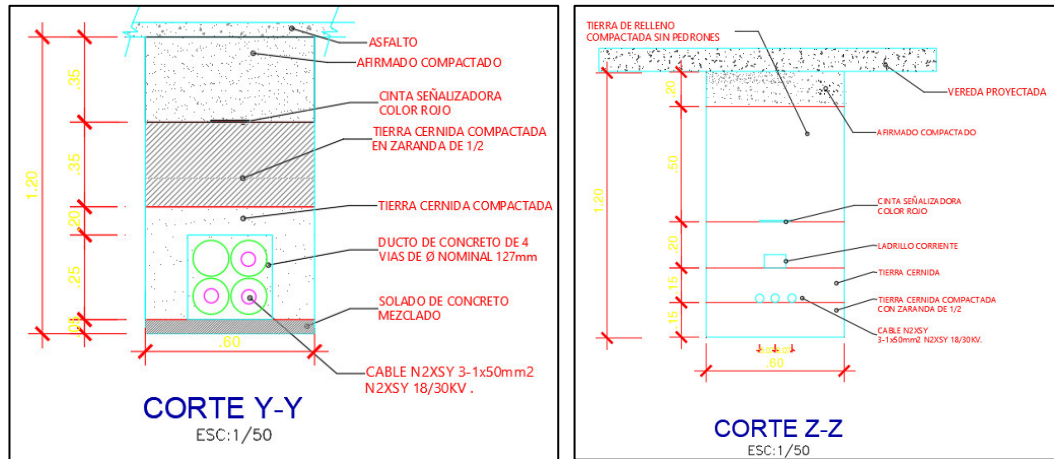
Recorrido detalle de construcción de red subterránea externa para cruce de pistas y veredas. Fuente: Daca Ingeniería y Proyectos S.A.C.
